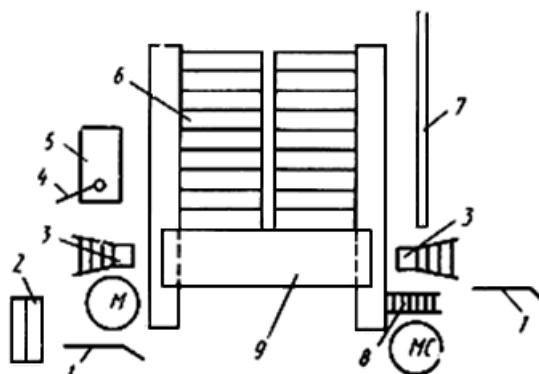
Схема организации рабочего места при монтаже лестничных площадок и лестничных маршей
